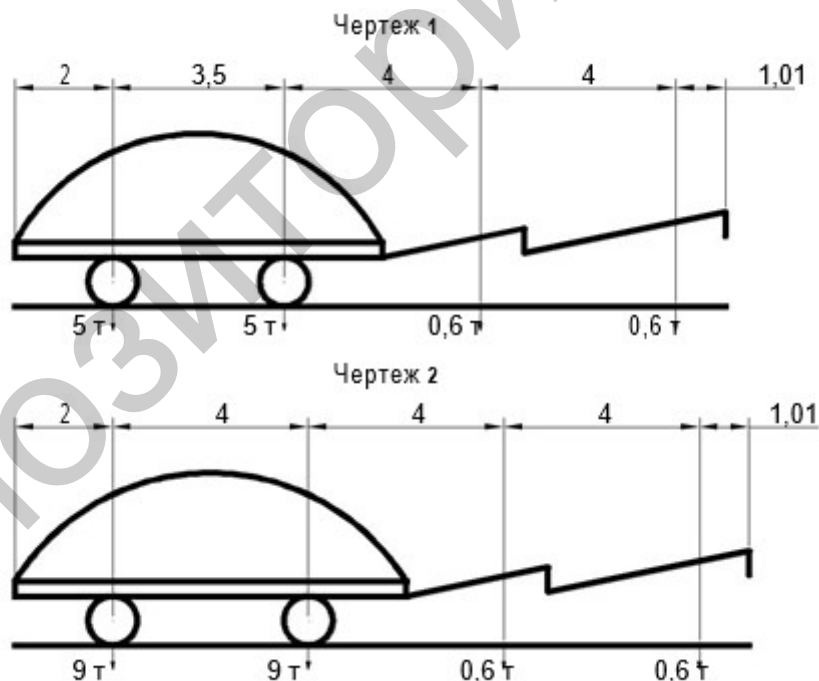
Схема установки дорожной нагрузки 1891г
